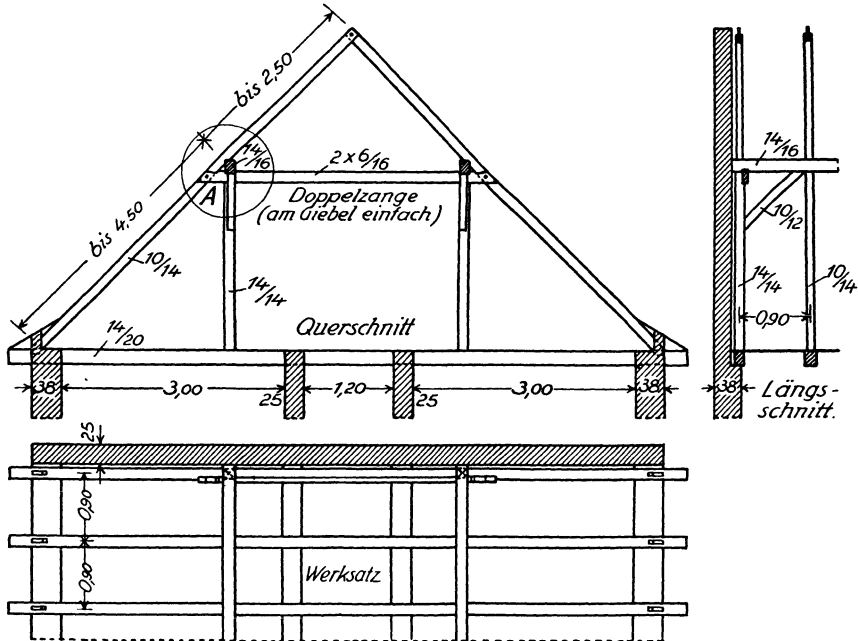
Pfettendach mit doppelt stehendem Stuhl.
